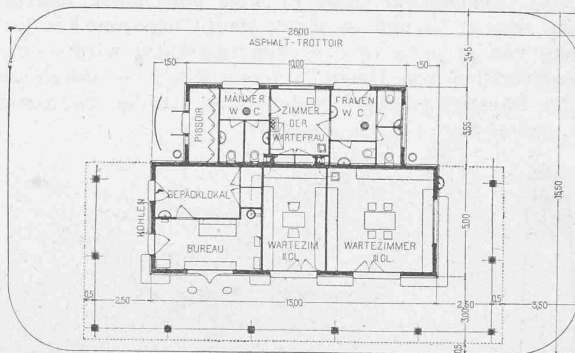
Birsigthalbahn-Station. — Grundriss 1:300.
